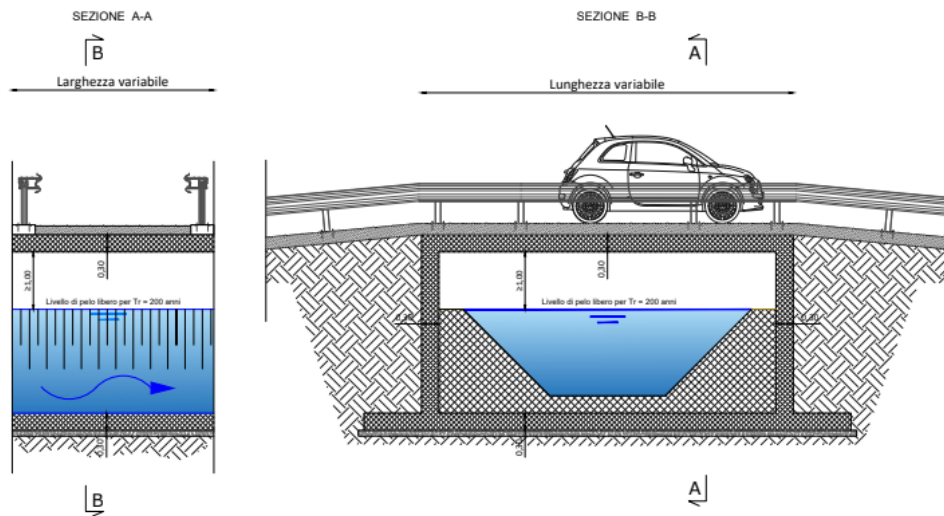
Sezione trapezia tipo e attraversamenti stradali
